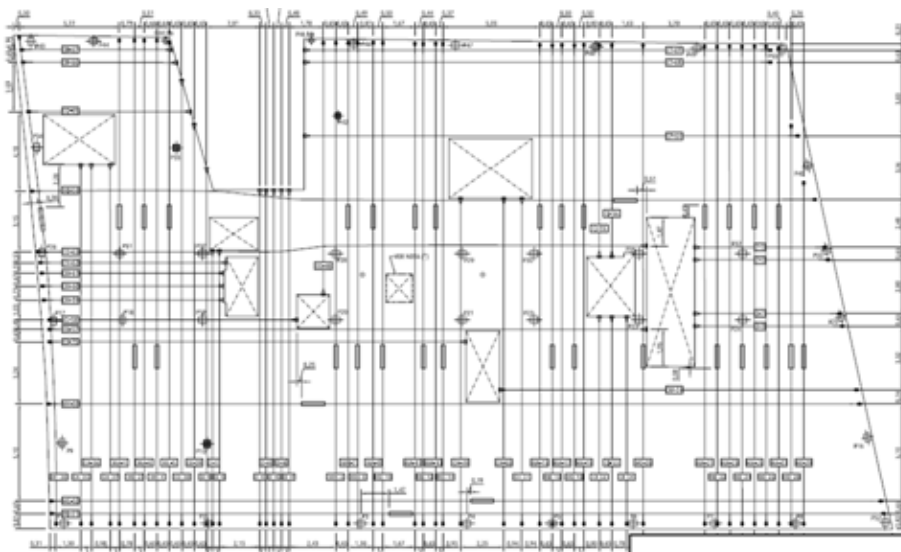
Planta de implantação dos cabos, elaborada pela empresa *Freyssinet* [B6]
